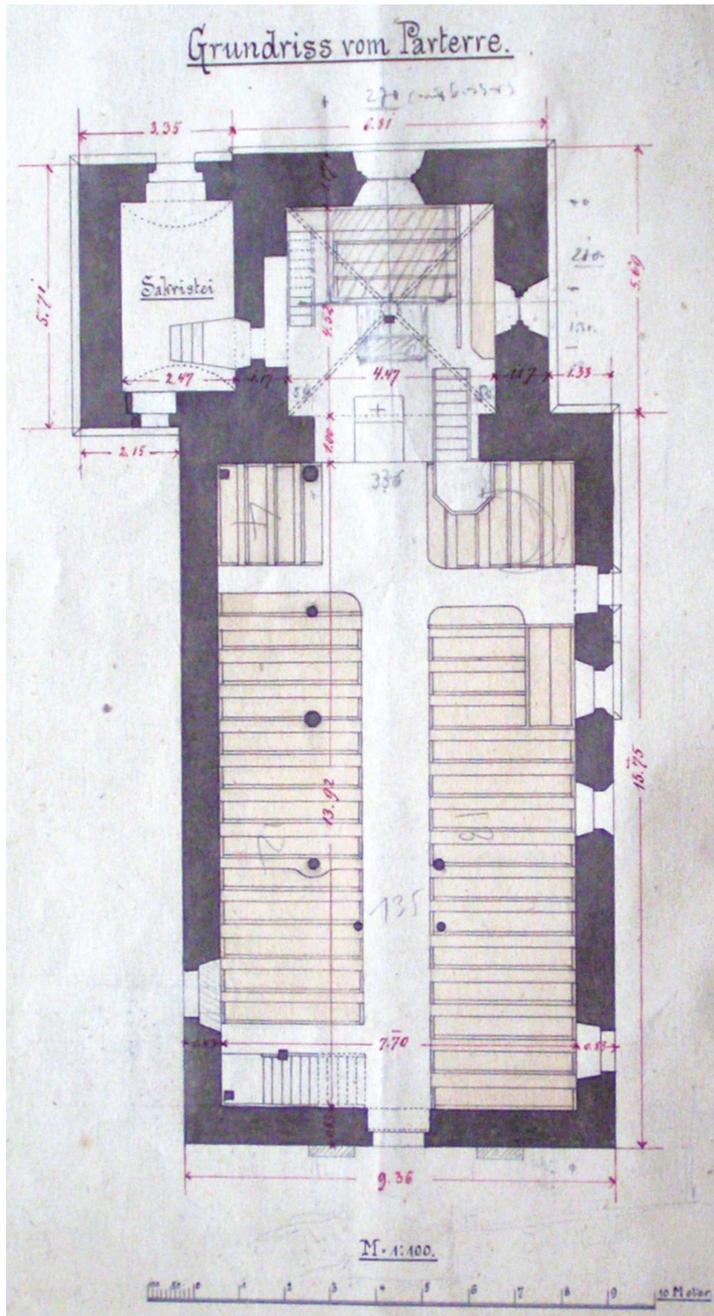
Grundriss der Bächlinger Kirche
